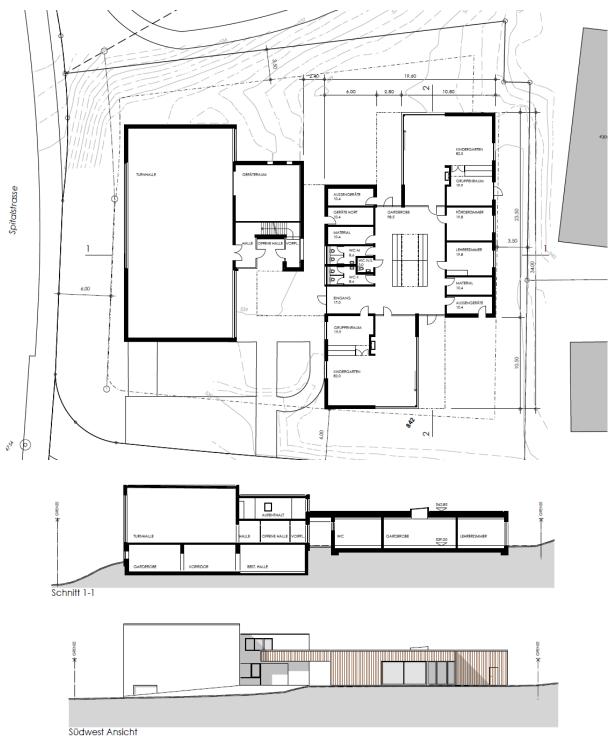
Grundriss, Schnitt und Eingangsfassade des Vorprojekts
